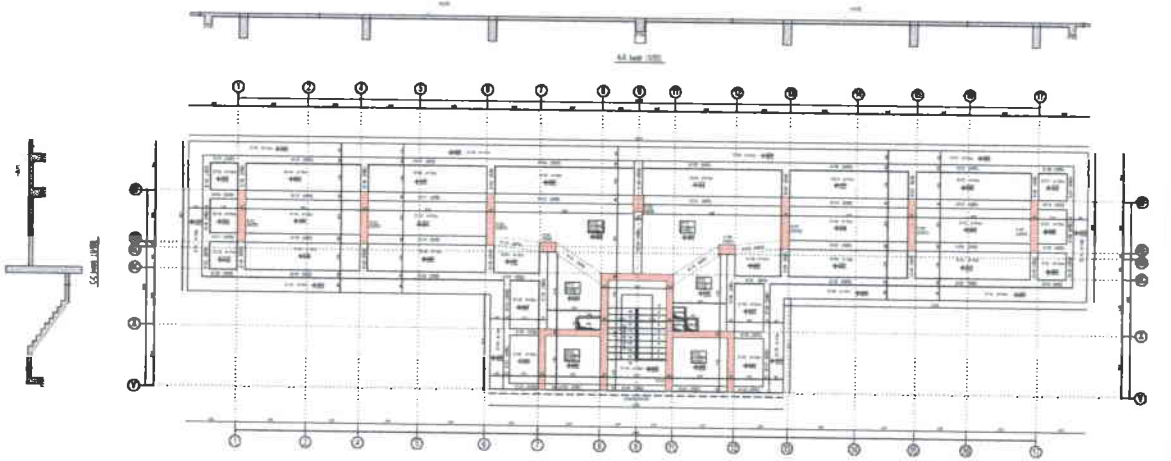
A1 blok 2.Bodrum Kat Kalıp Planı
